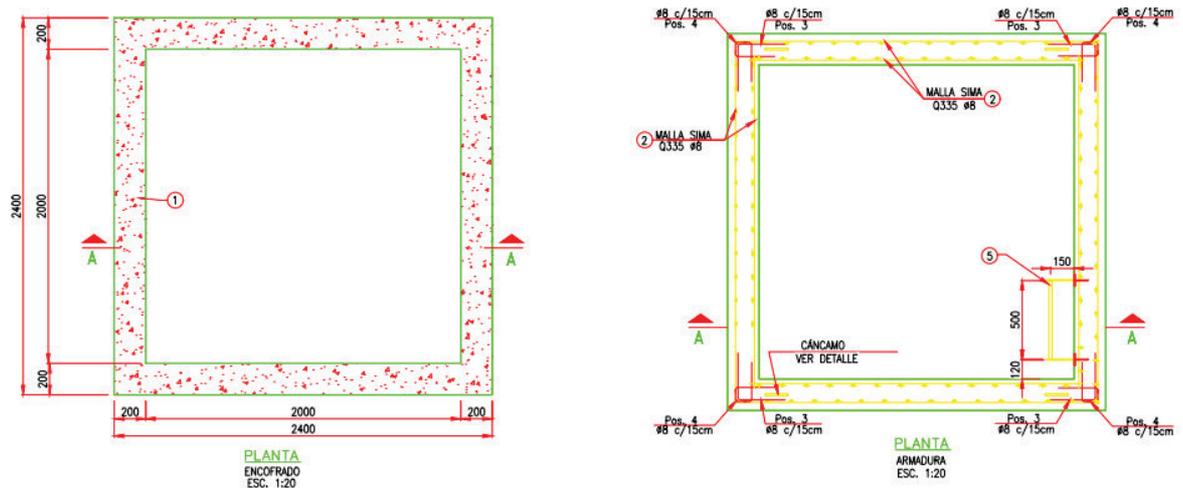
Vista en planta de cámara. Hormigón y armadura.
